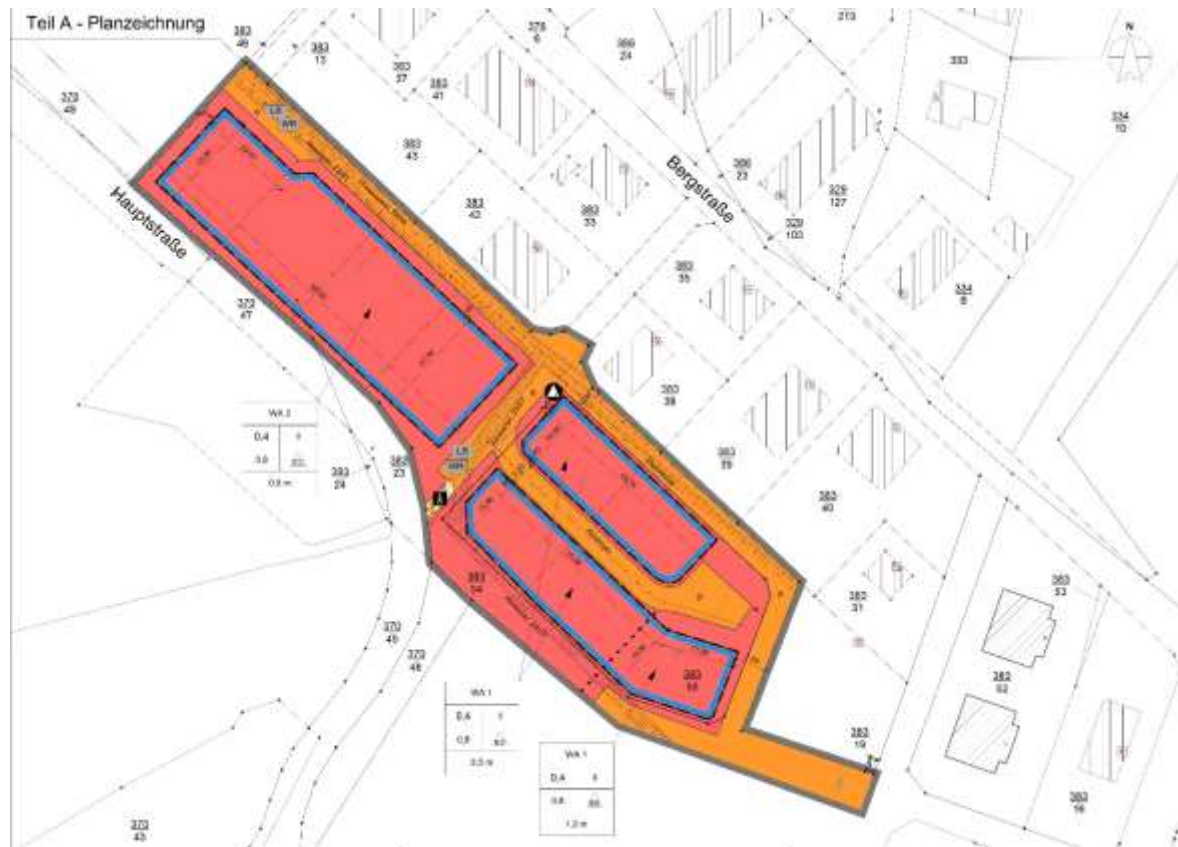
Plangebiet, Teil A - Planzeichnung
